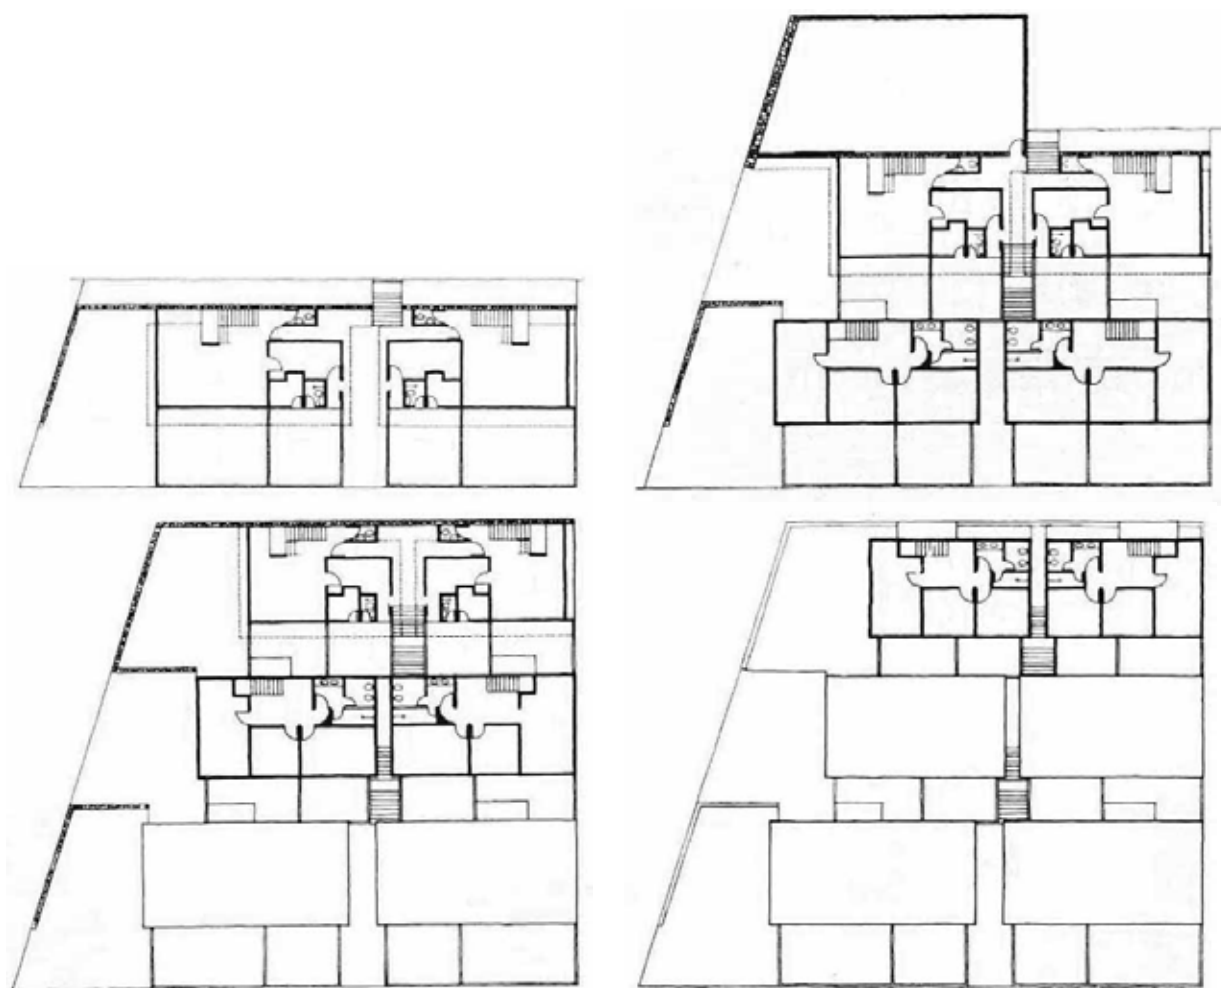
(sup. esq.) planta nível 0,00: térreo (circulação central descoberta, hall, lavabo, sala, área de serviços e jardins).
